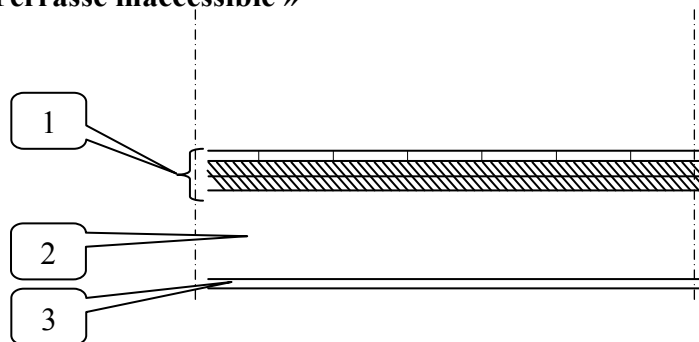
Coupe transversale du plancher terrasse inaccessible
